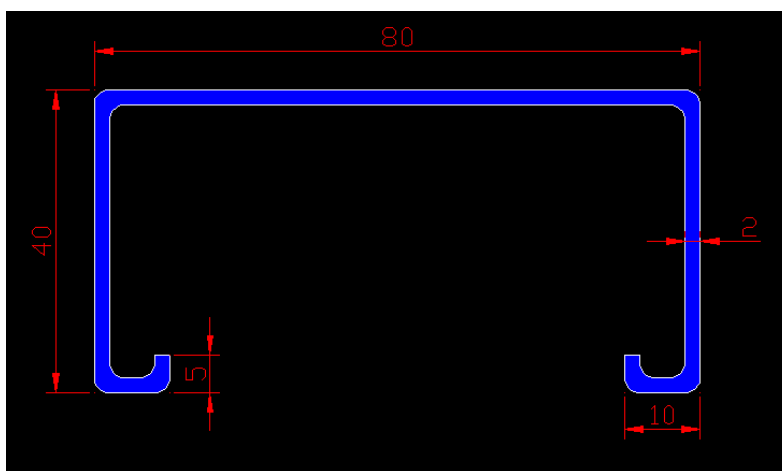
Dimensionamiento del Perfil de la Viga.
